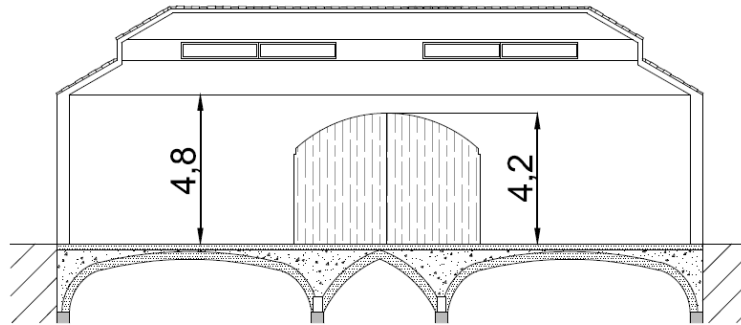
Vista simplificada de la secció B-B' del Plànol 20. Vistes en planta i alçat de la planta superior de la nova edificació.
